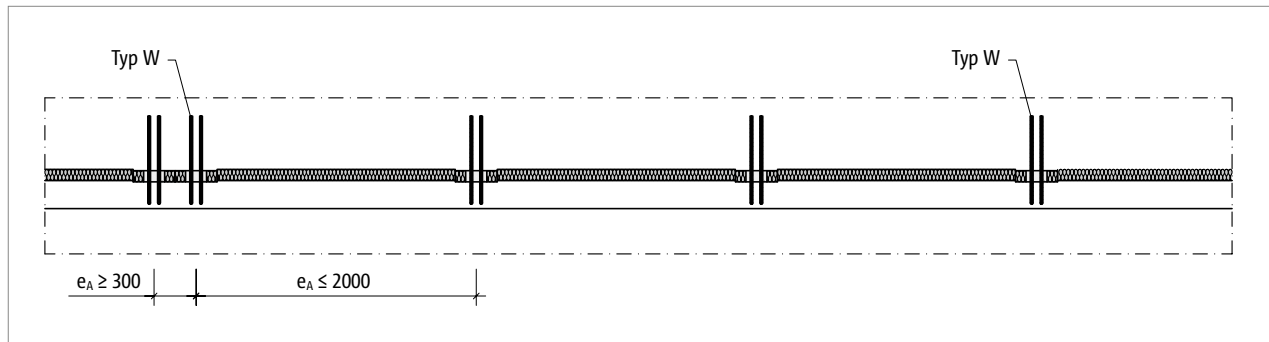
Schöck Sconnex® Typ W: Minimaler und maximaler Achsabstand e_A
